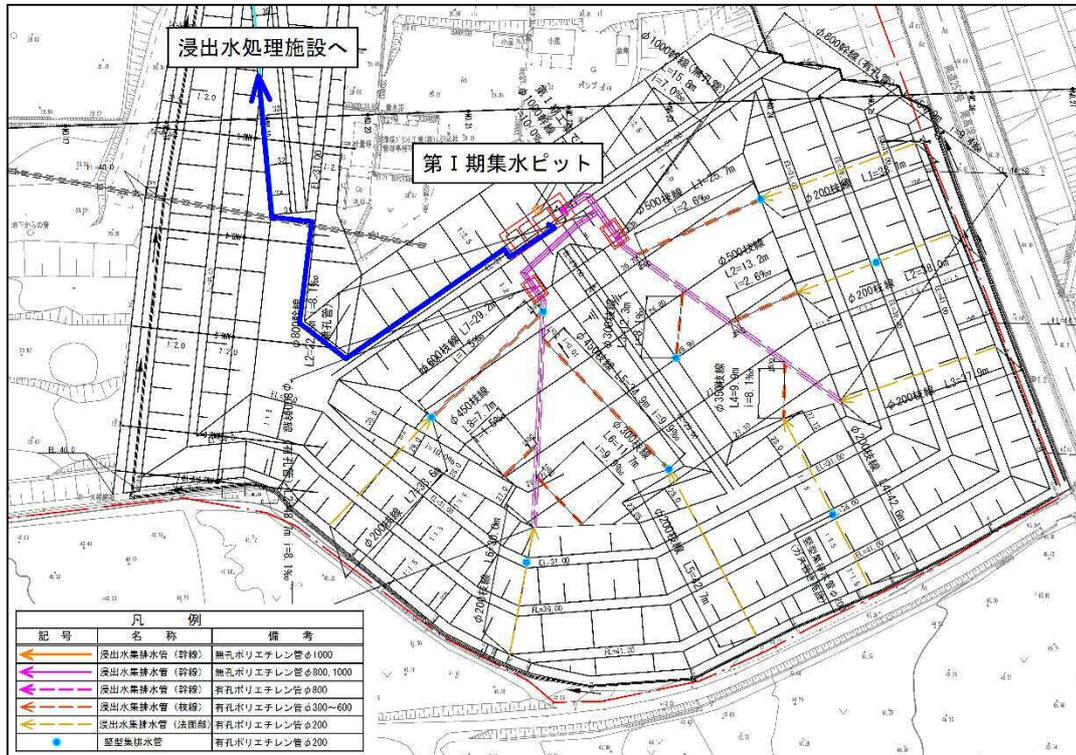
浸出水集排水施設配置計画平面図 (第Ⅰ期)
